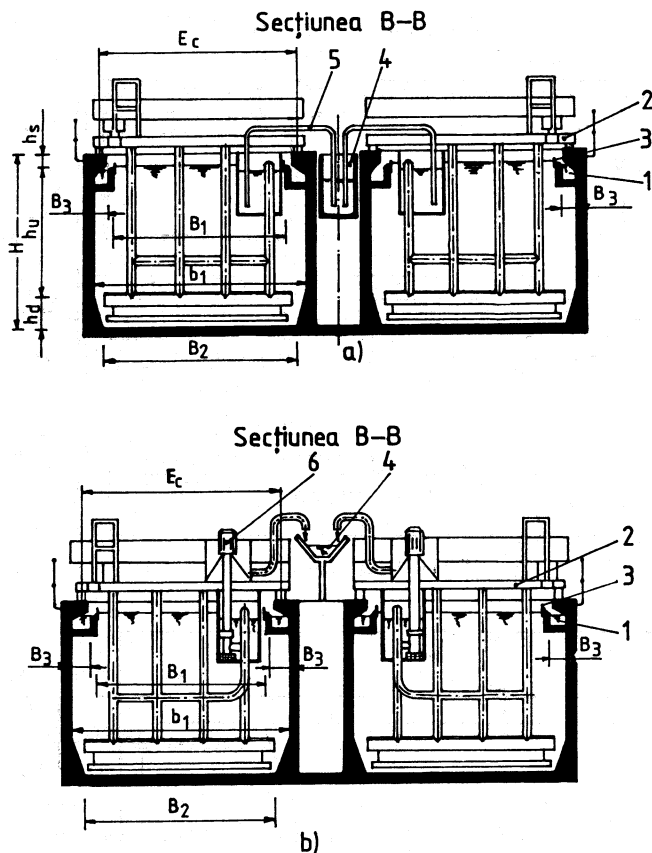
Secțiuni transversale prin decantorul secundar orizontal longitudinal
